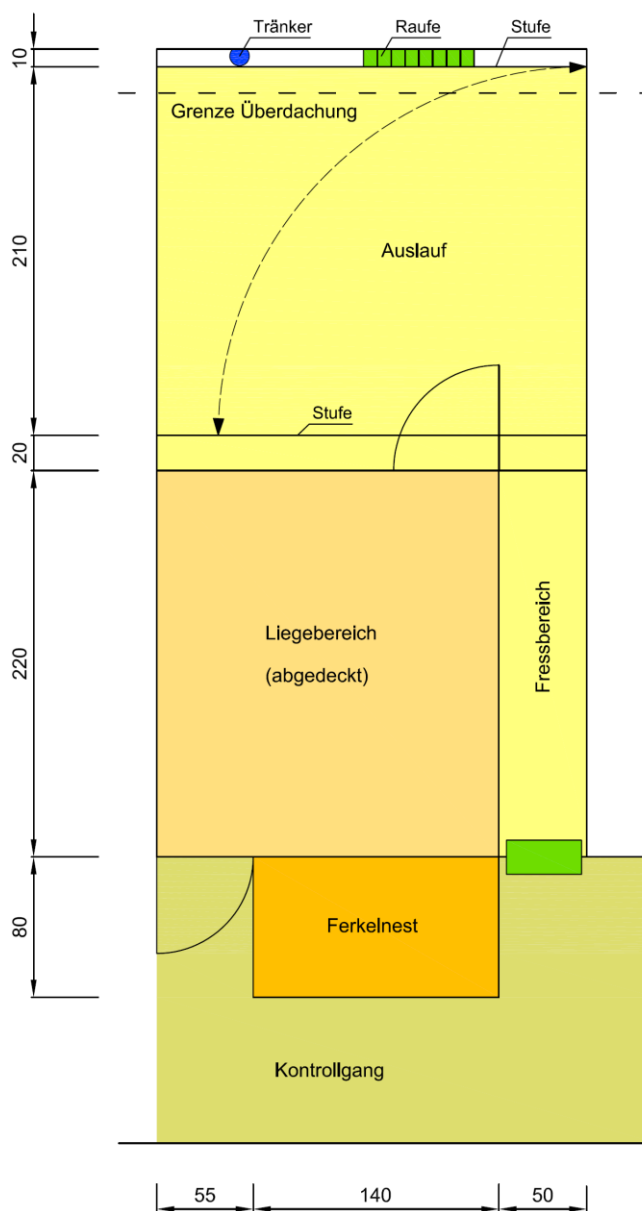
Grundriss der „Welser Abferkelbucht“ (nach ÖKL, alle Maßangaben in cm)
